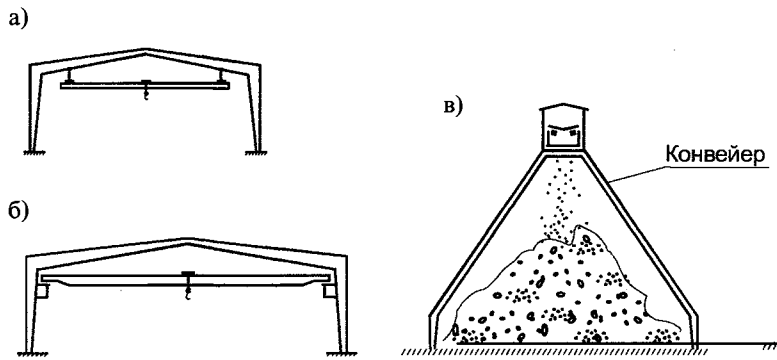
Крановое и технологическое оборудование в зданиях с каркасами из рамных конструкций
